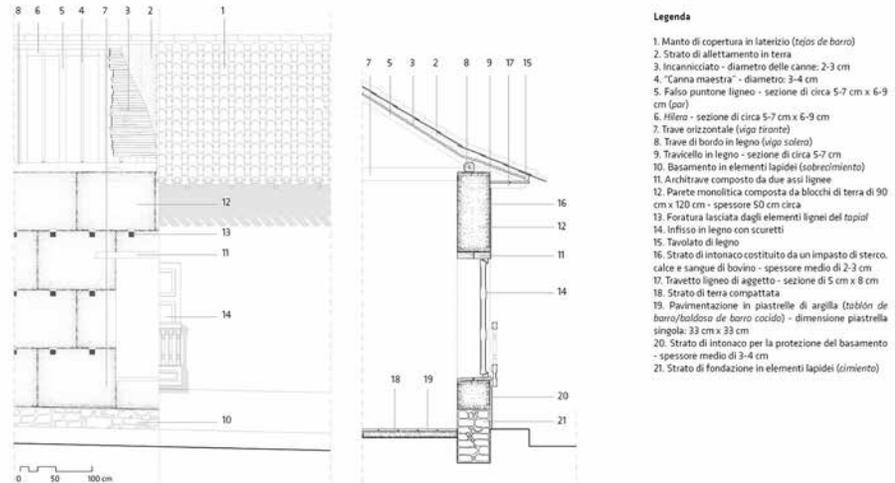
Modellazione di un edificio analizzato- Prospetto con sfogliato e sezione di un muro maestro.
